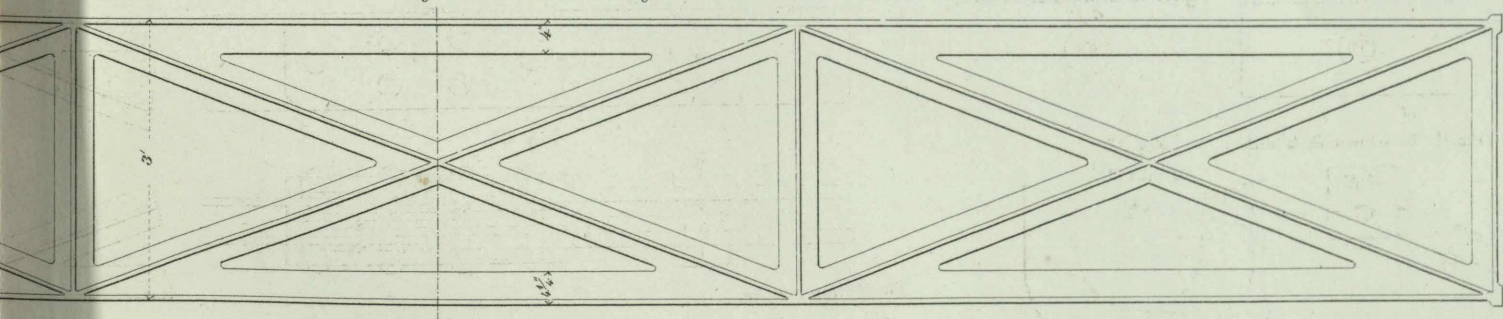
Grundriss eines gusseisernen Trägers.
